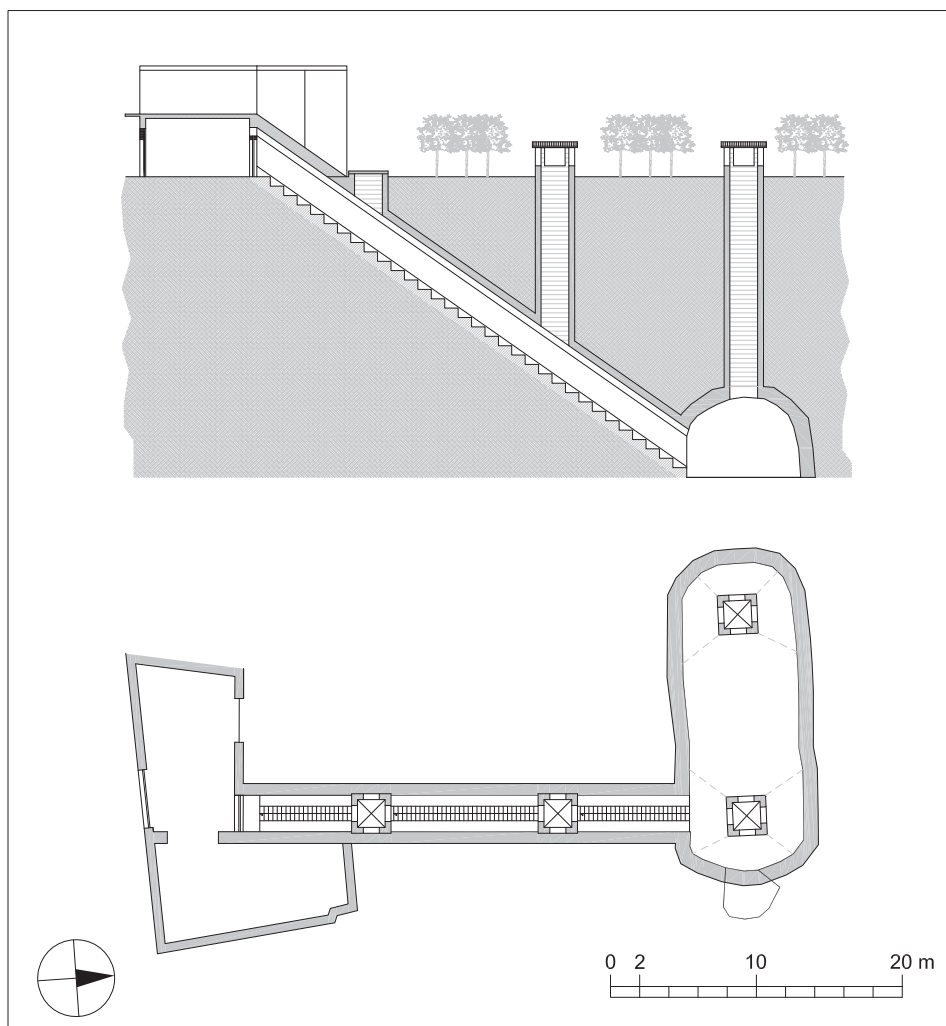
Gallo, cantina C12. Pianta e sezione trasversale.
